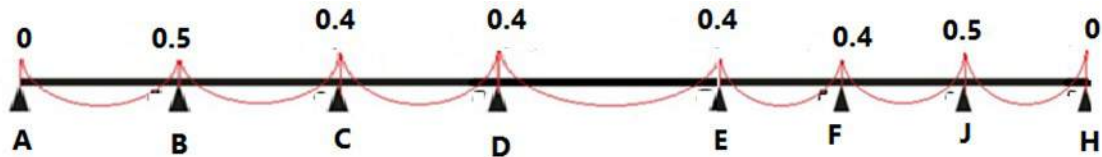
Schéma du 1^{eme} type de poutrelle.
